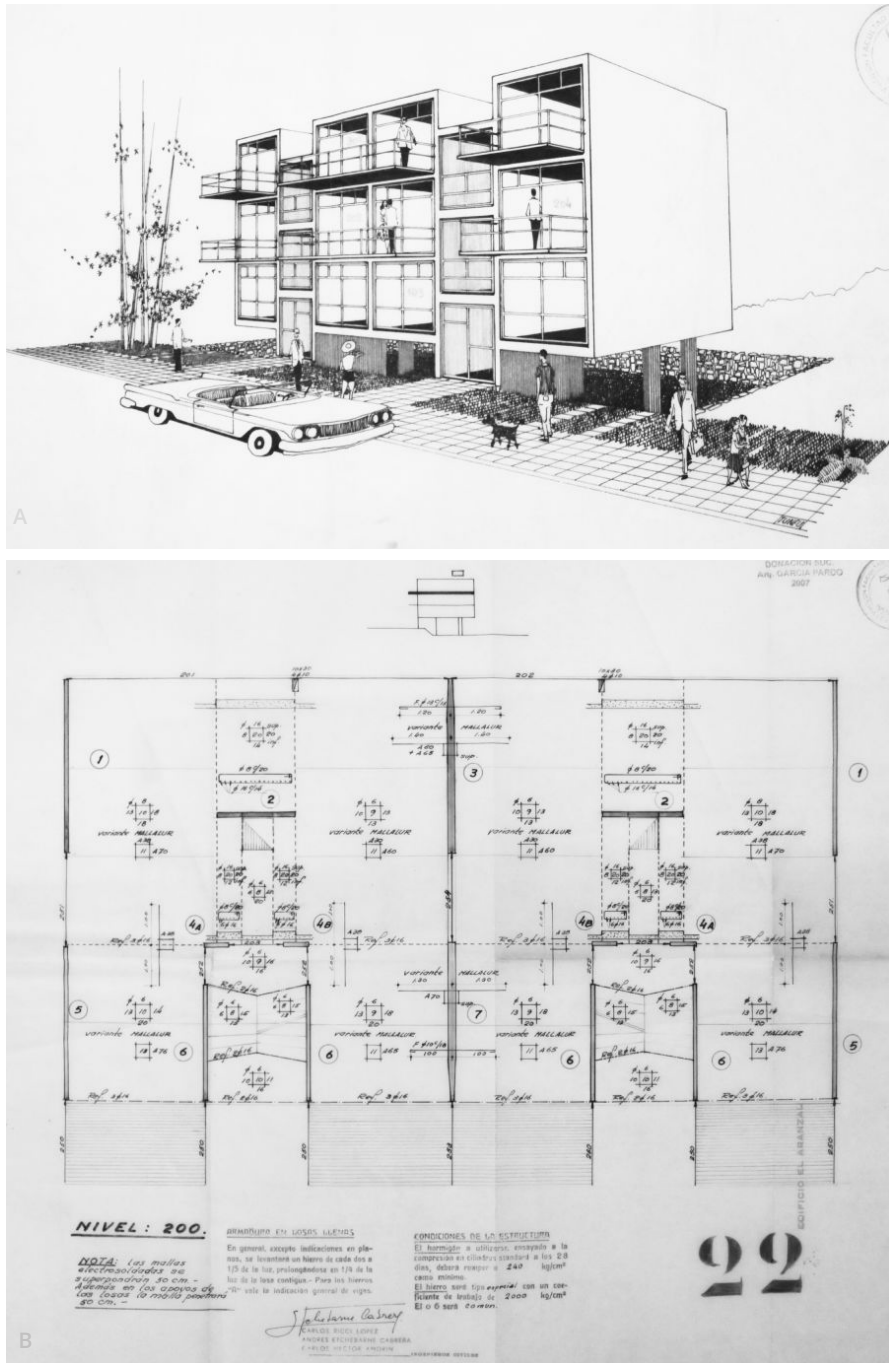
El Aranzal: A. Axonometría. B. Planta de estructura.
